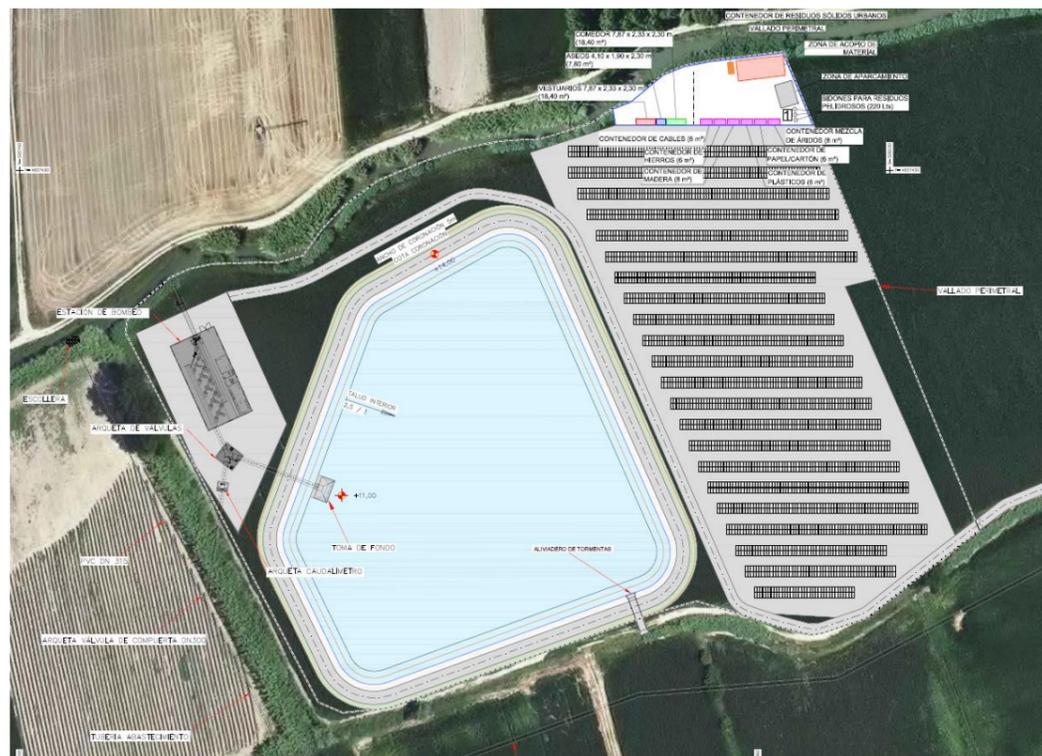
Planta general de la zona de instalaciones auxiliares próxima a la balsa a pie de canal
